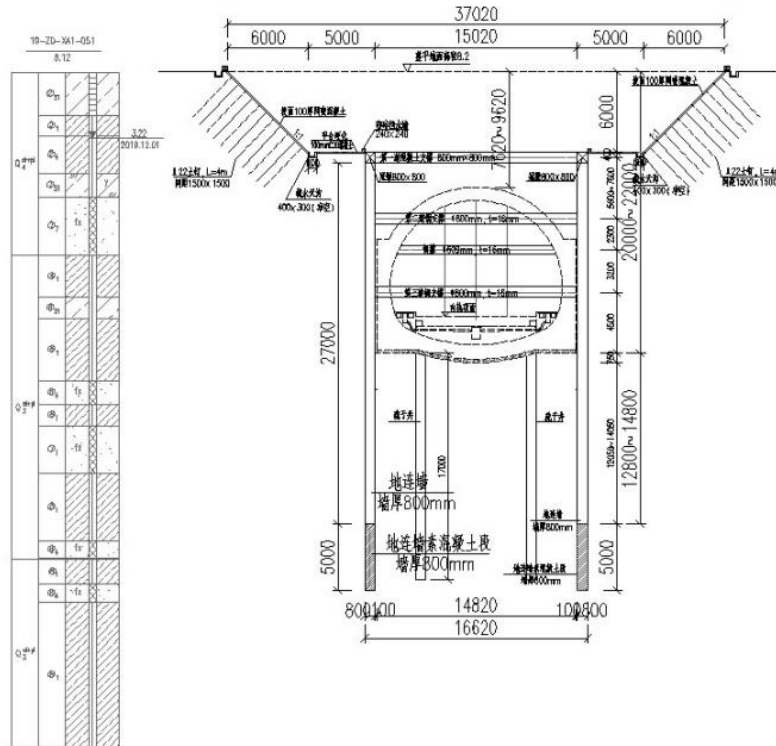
深基坑放坡+地连墙+内支撑形式典型横断面示意图
